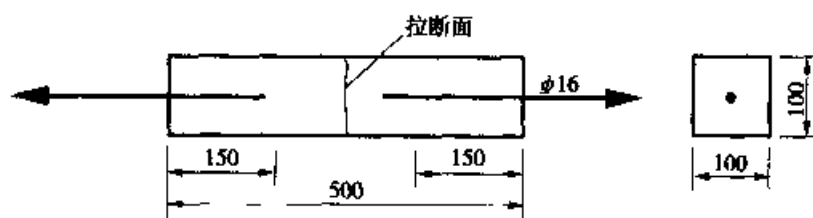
混凝土直接受拉试验(尺寸单位:mm)
